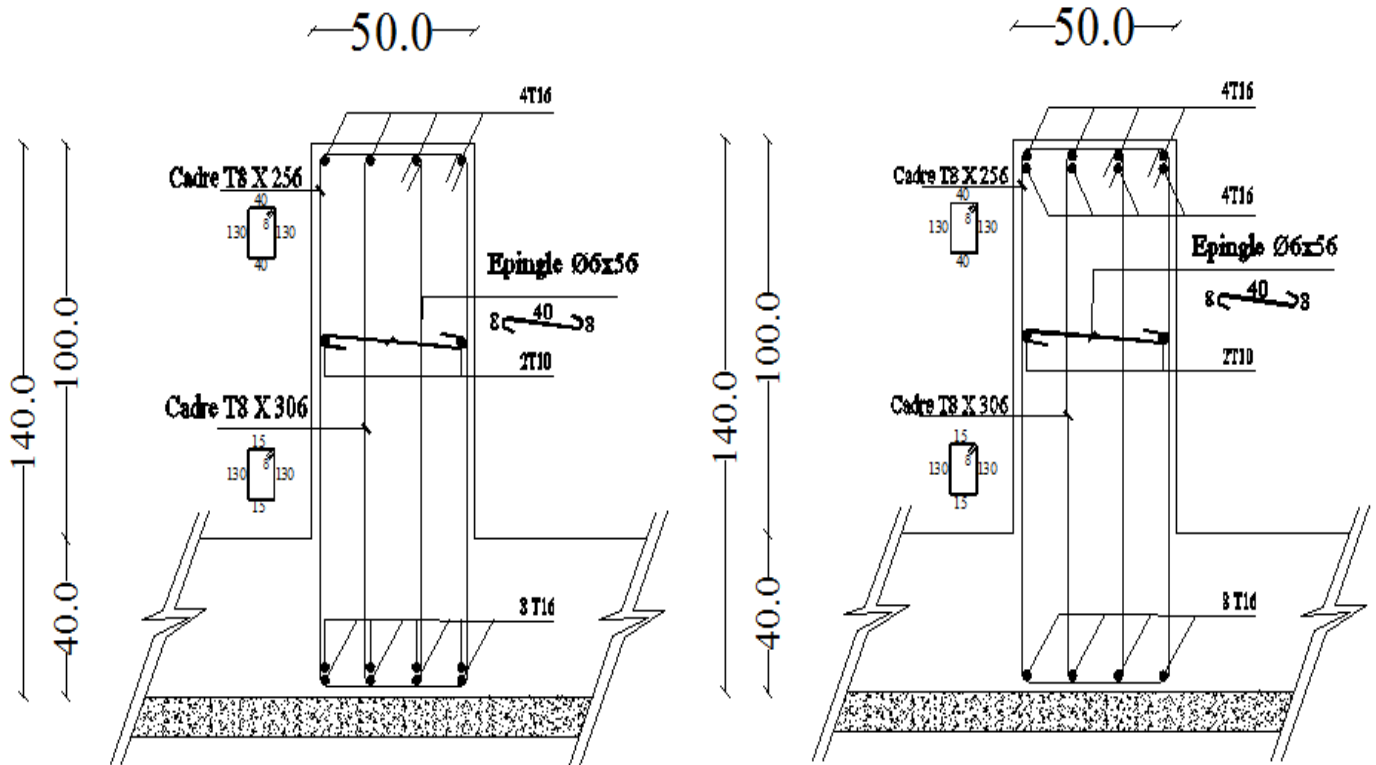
Dessin de ferrailage d'une poutre principale
